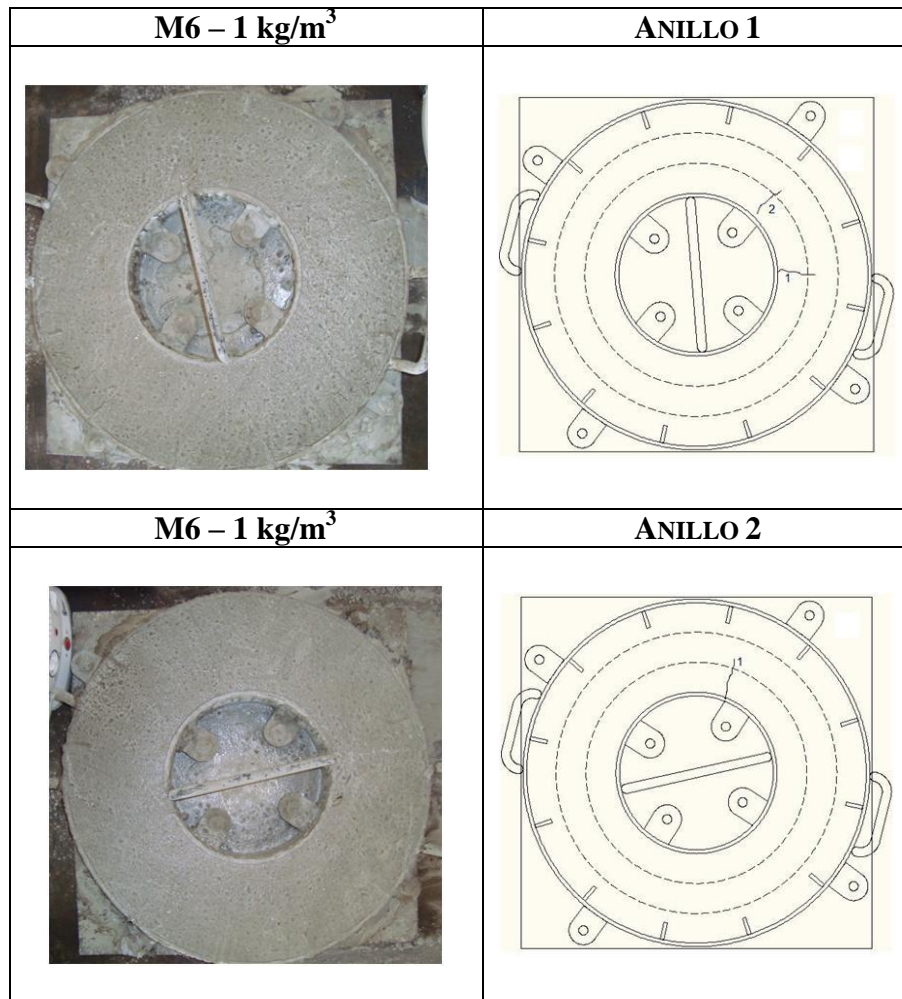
Grietas de Contracción Plástica de la Mezcla 6
